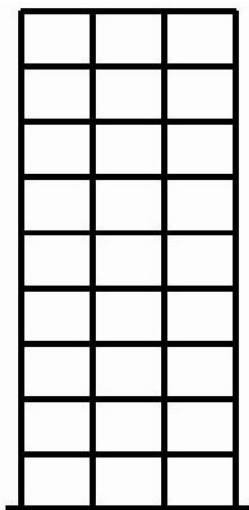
Разрез рамного каркаса многоэтажного здания
